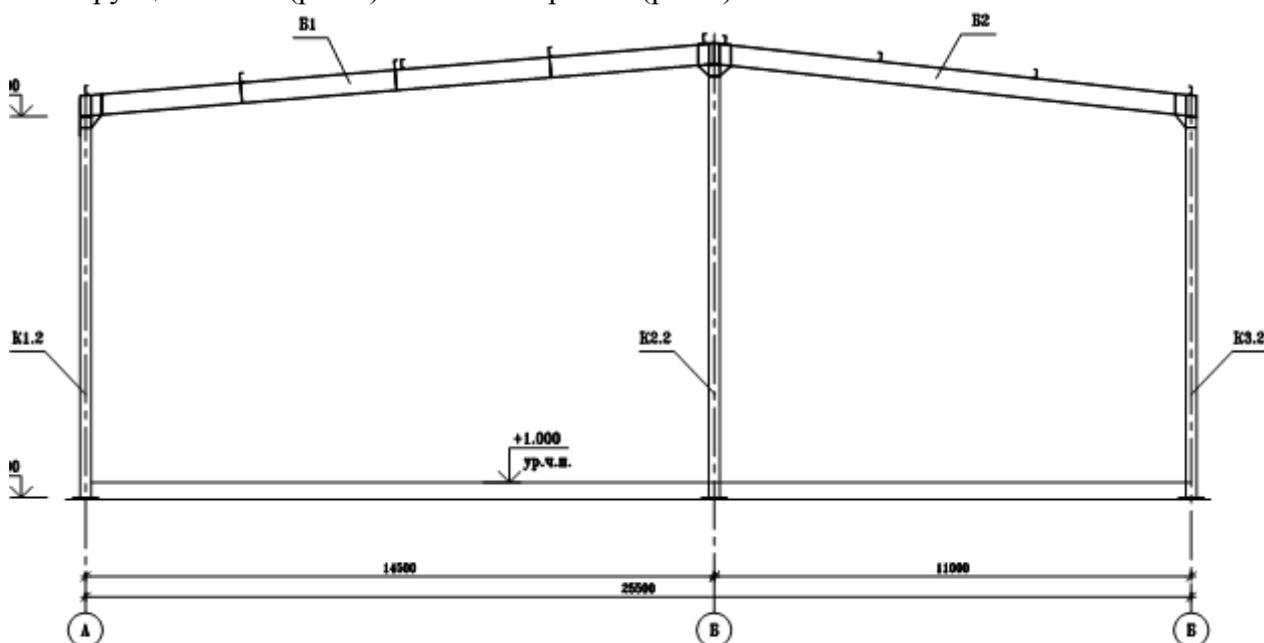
где К1.2, К2.2, К3.2 -колонны; Б1, Б2-фермы;
